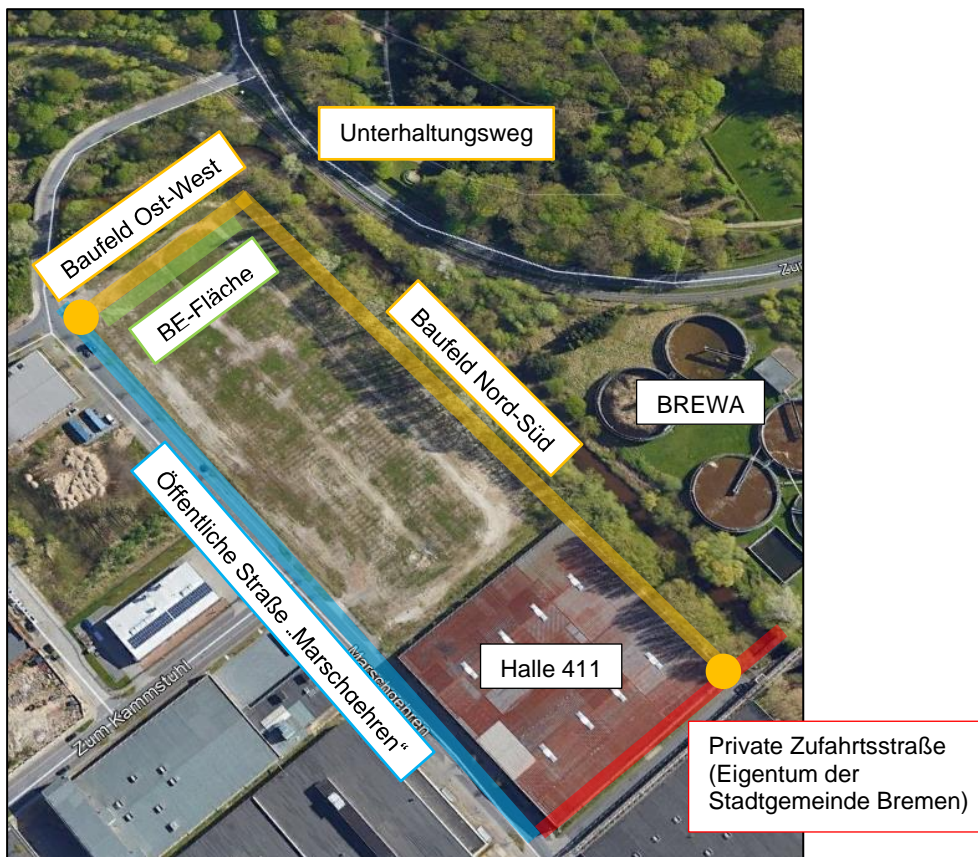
Baufeld, Baustelleneinrichtungsfläche und mögliche Zufahrten [1]
